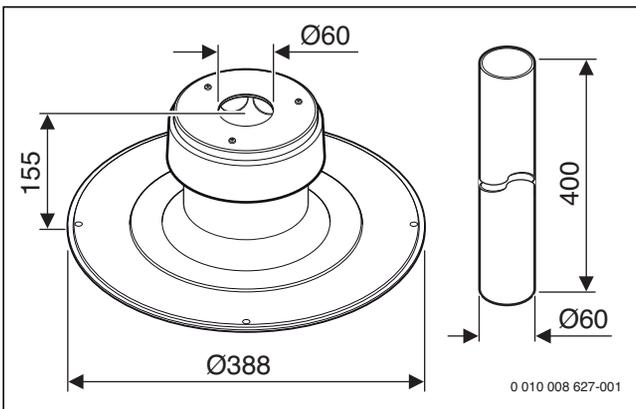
Schachtabdeckung für 60 mm, Aluminium (Maße in mm)
